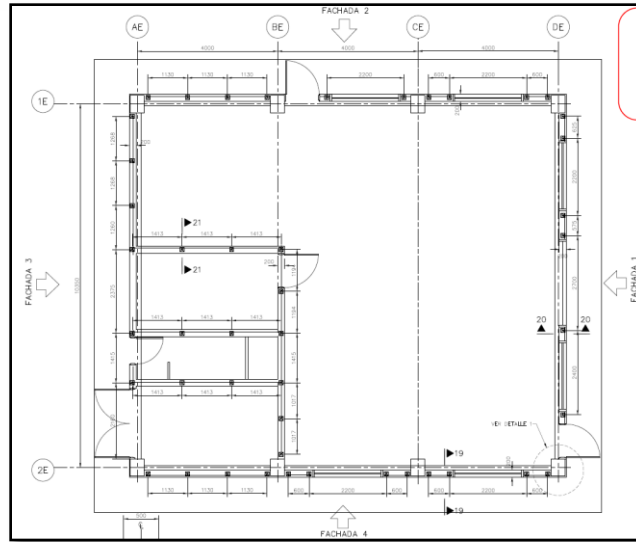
Planta de ubicación de dovelas de refuerzo y anclaje en mampostería
